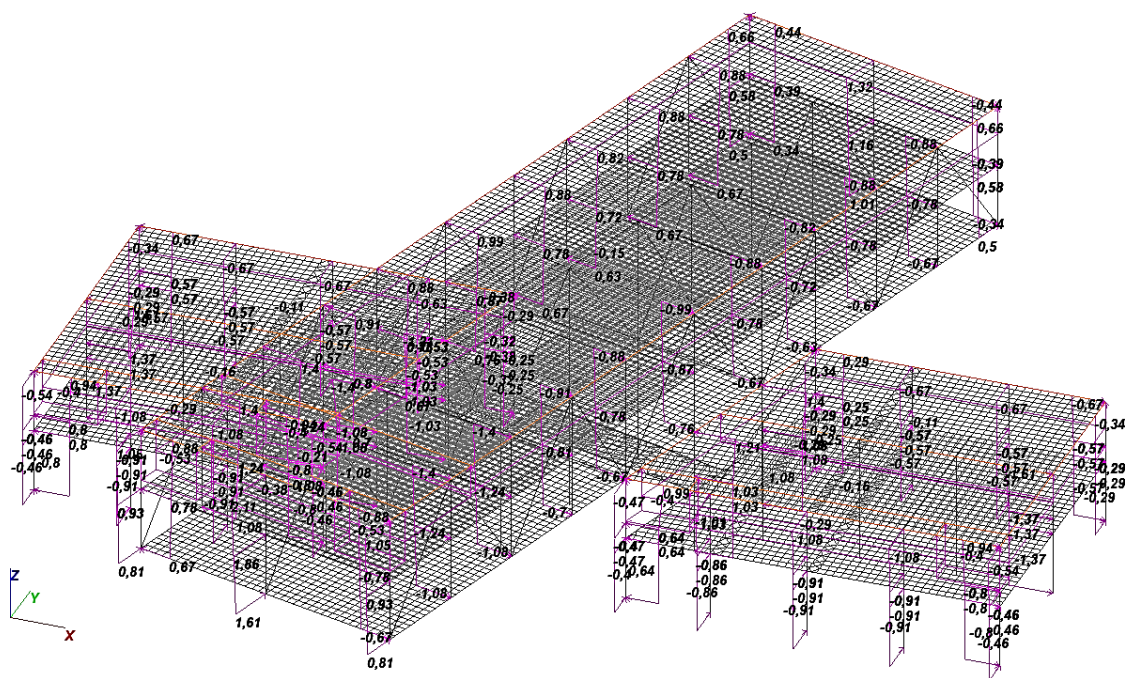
Схема рикладання вітрового навантаження по осі У на будівлю
